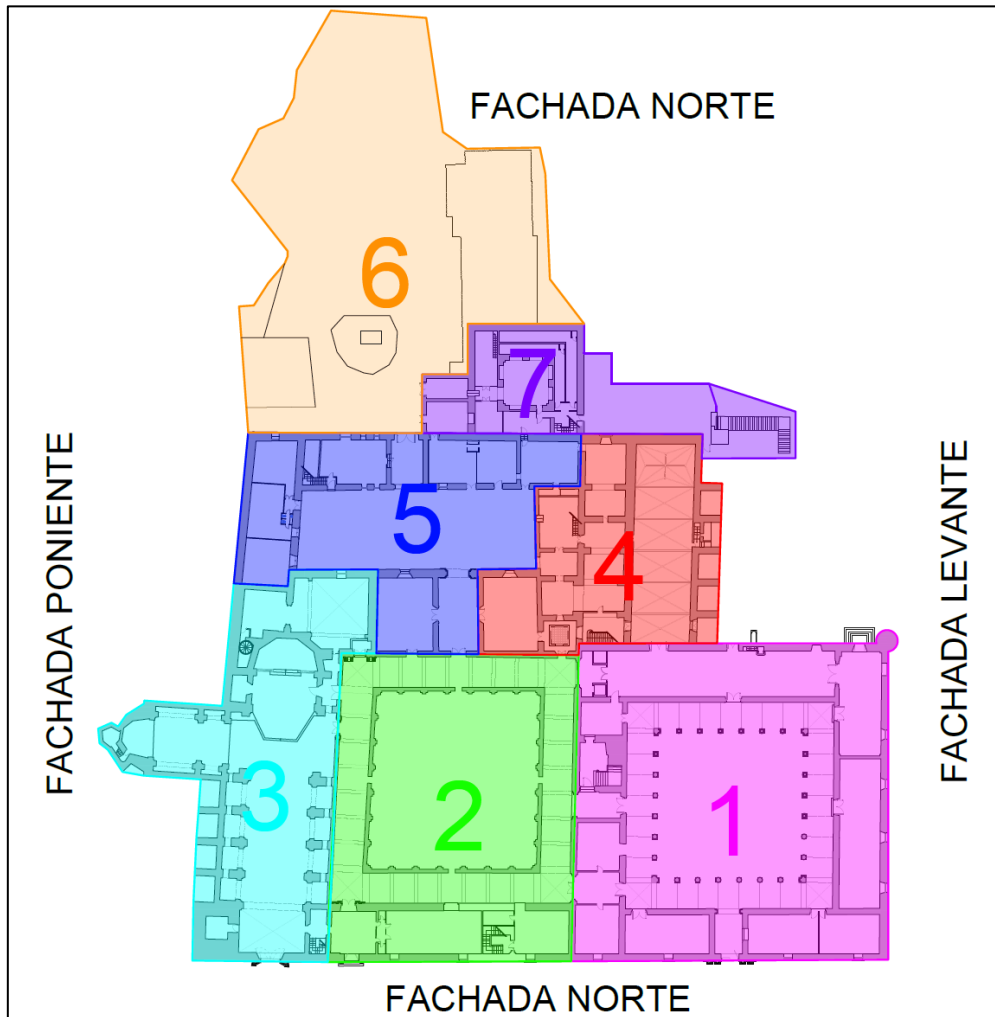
Zonificación general del plano, tomando como base la planta baja.
